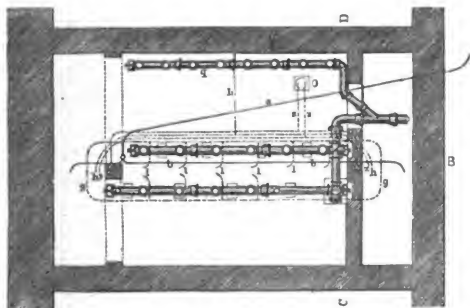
Grundriss der Retirade. 1. Für Herren. 2. Für Frauen.
